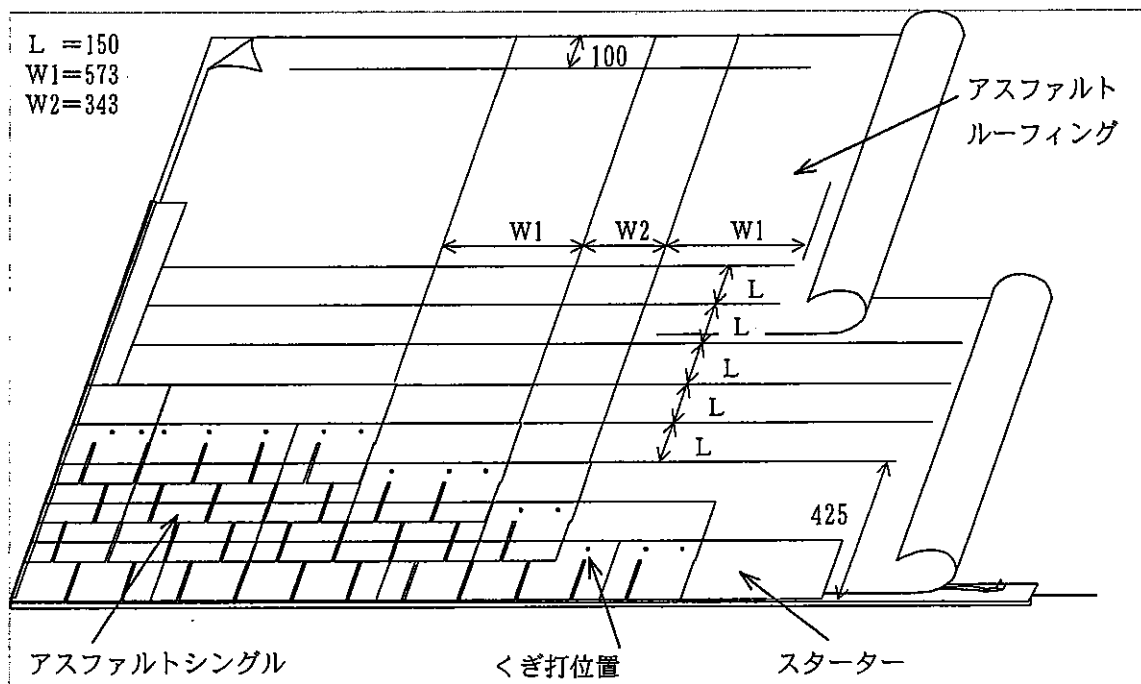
申請仕様の施工図 (アスファルトシングルの施工: 1タブ~4タブ)
